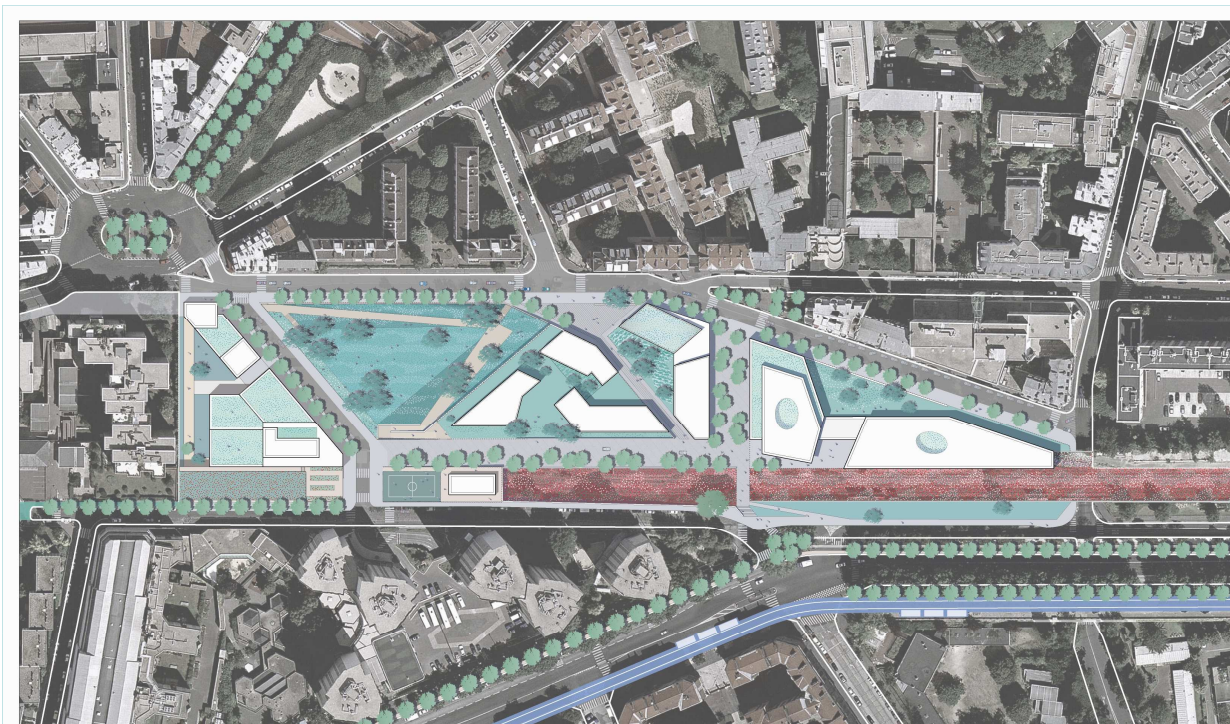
Plan masse de la ZAC de Rungis / Bruno Fortier, Architecte coordonnateur
